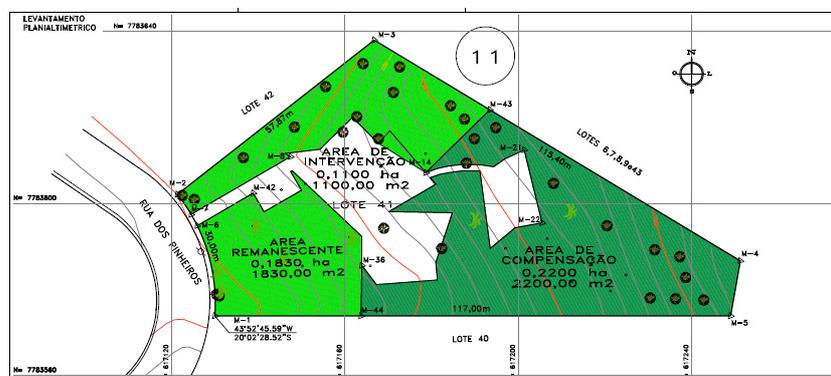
Levantamento Planimétrico - área de compensação. Fonte PECF 2017
